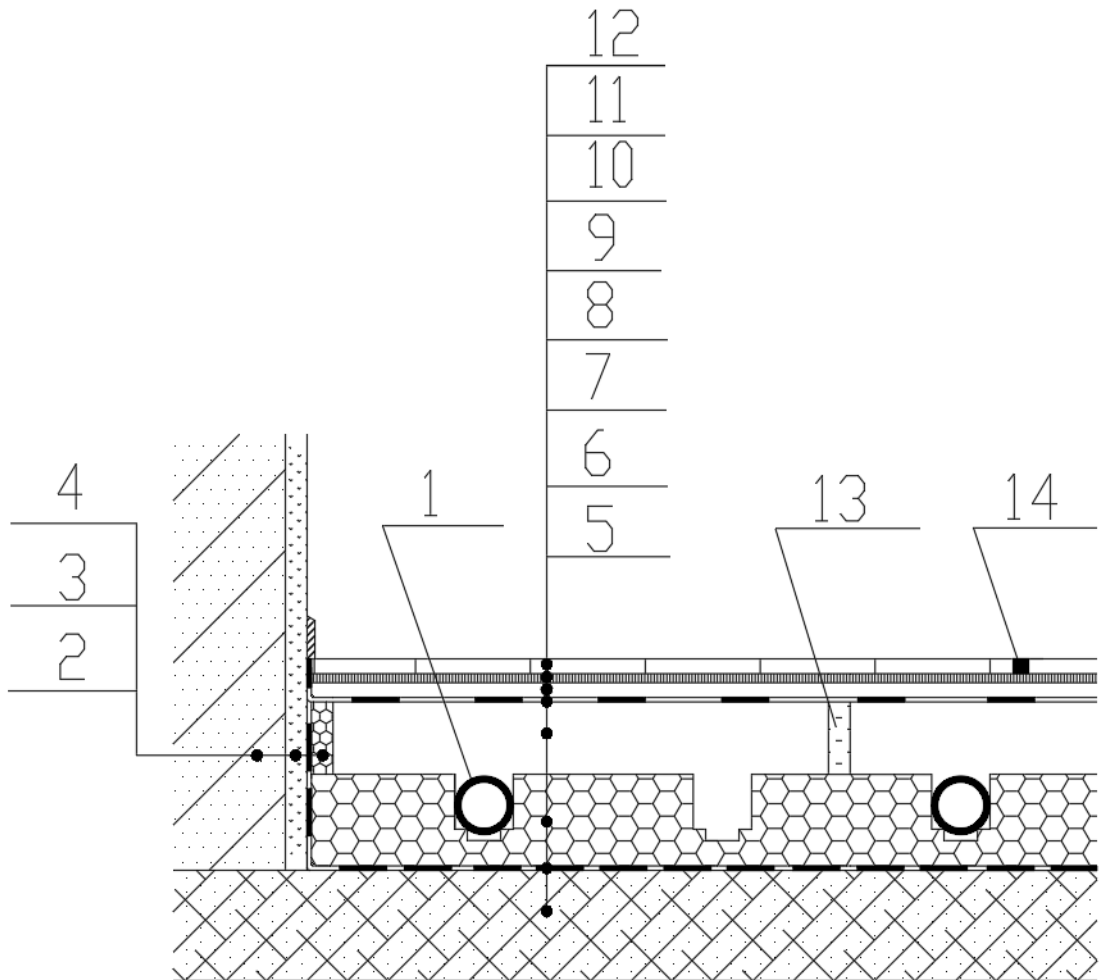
采用 EPS 覆膜和 SEPS 绝热模块板的混凝土填充式热水地暖地面构造
